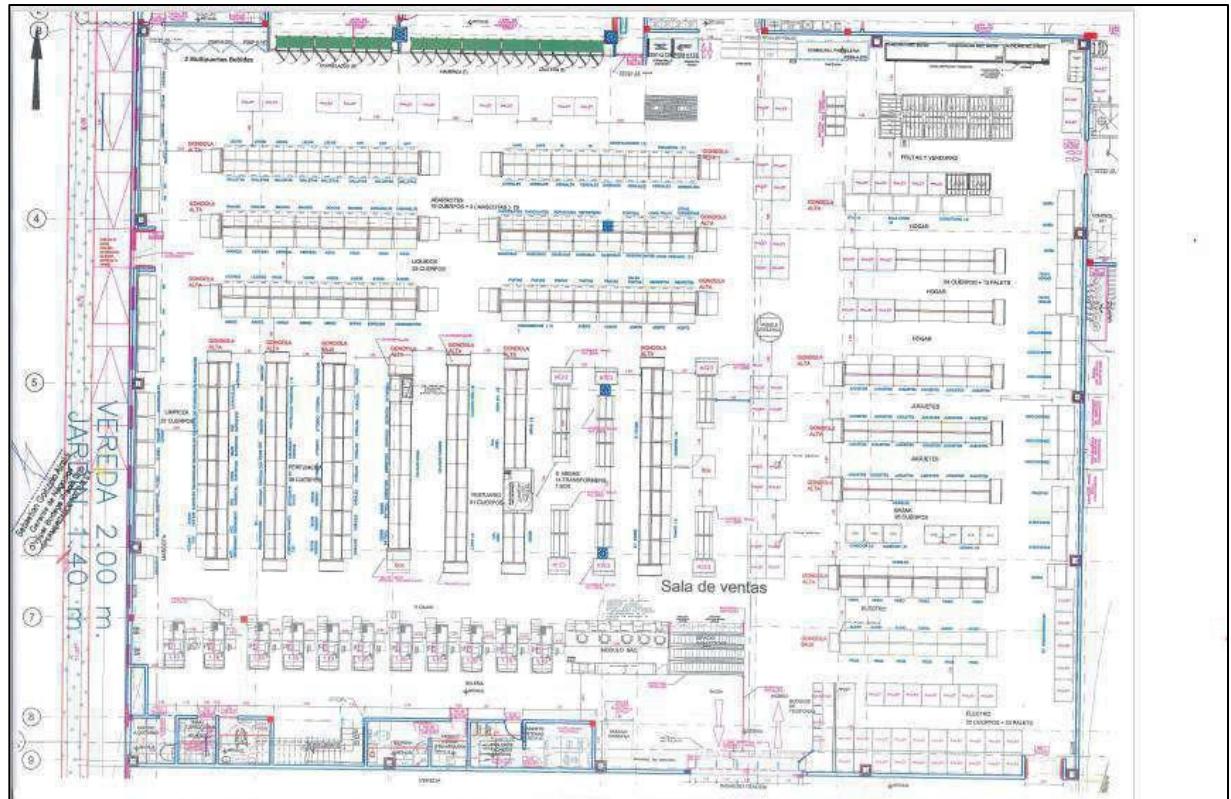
Planta Macro Layout y Micro Layout Aprobado
